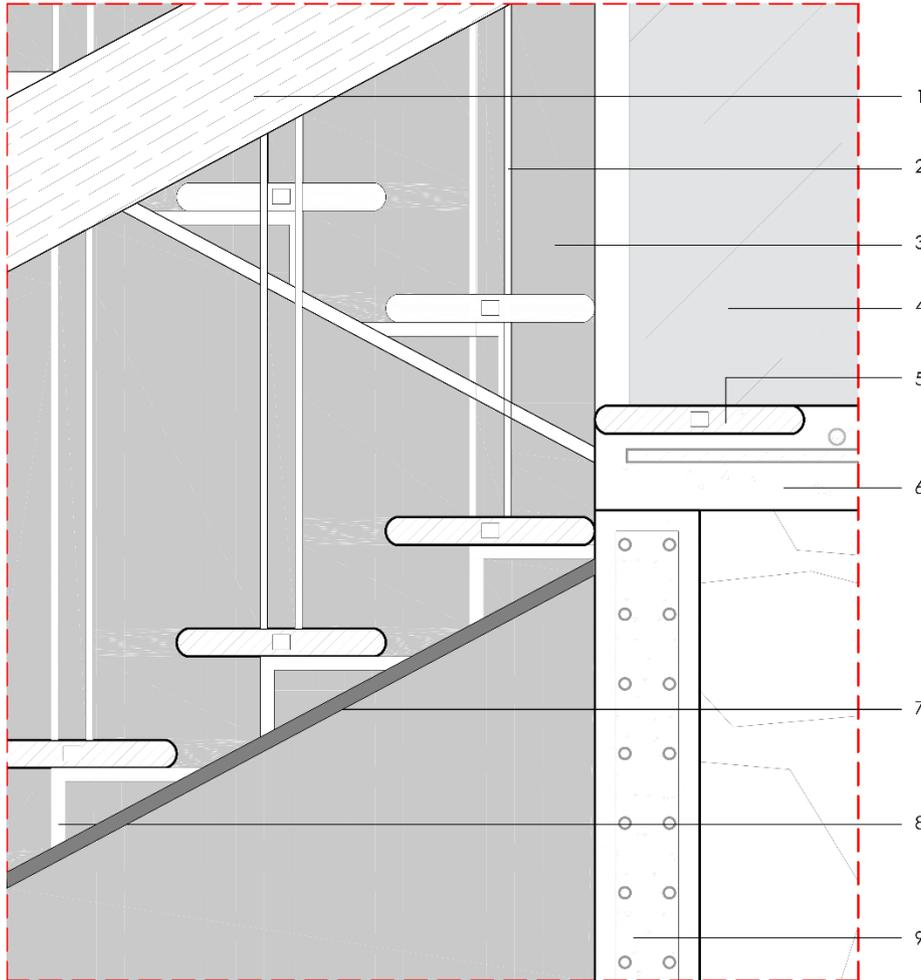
Detalle Constructivo 2, Casa Moncayo
